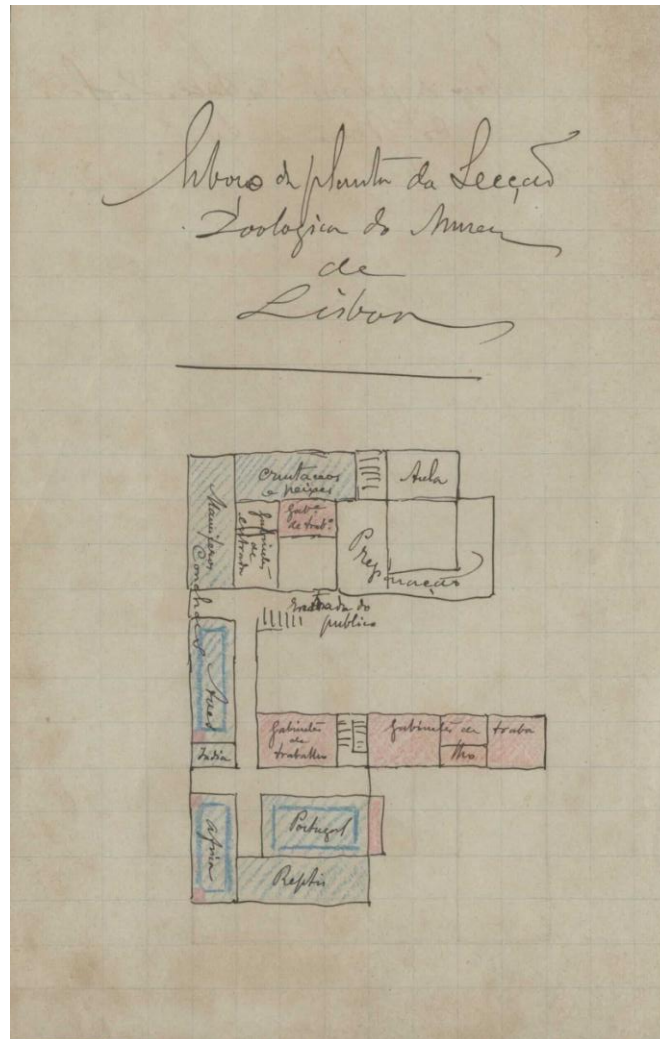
Planta da secção Zoológica em meados da década de 1880, desenhada por Arruda Furtado.
